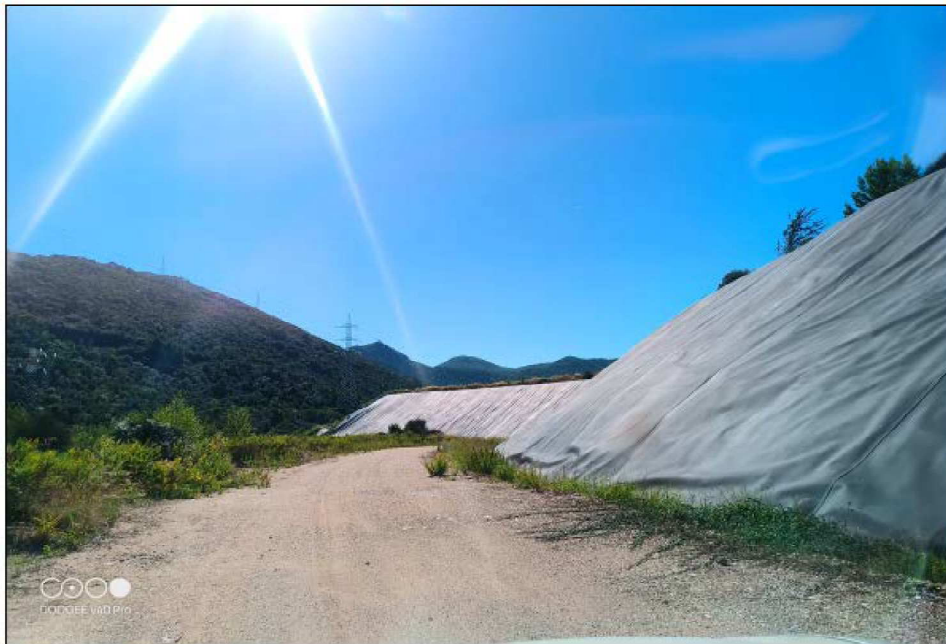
Esistente impermeabilizzazione scarpata zona deposito scorie – oggetto di connessione alla futura impermeabilizzazione di MISP
